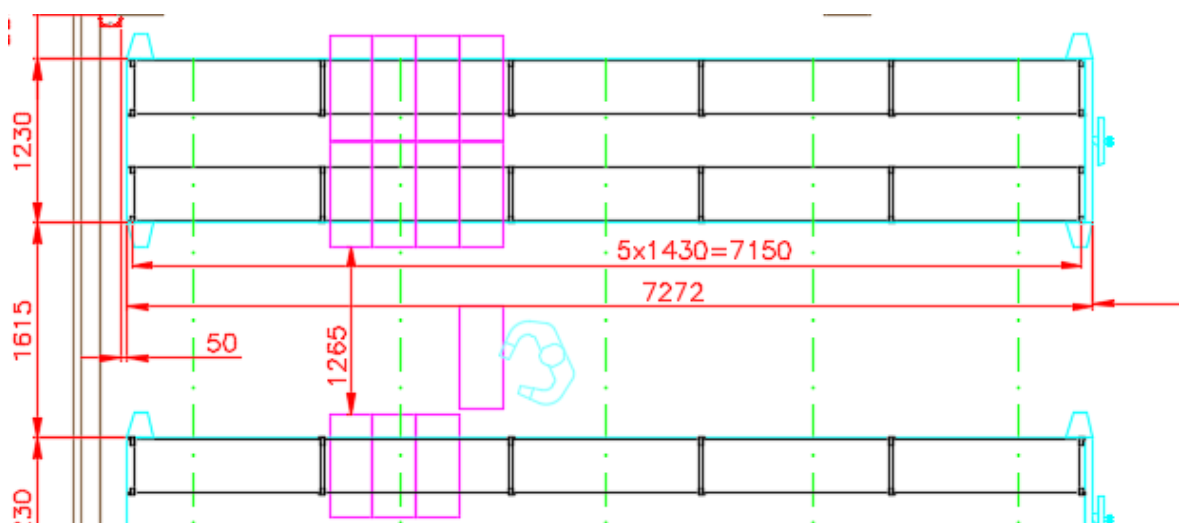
CAD výkres pro pojízdné regály v poli D [Autor]
